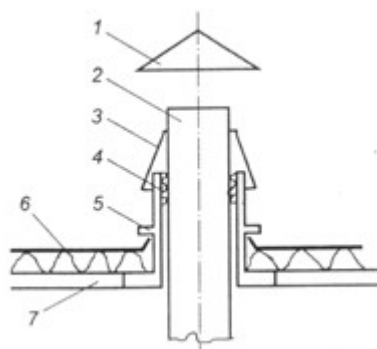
Узел пересечения кровли одиночным выхлопным воздуховодом.
